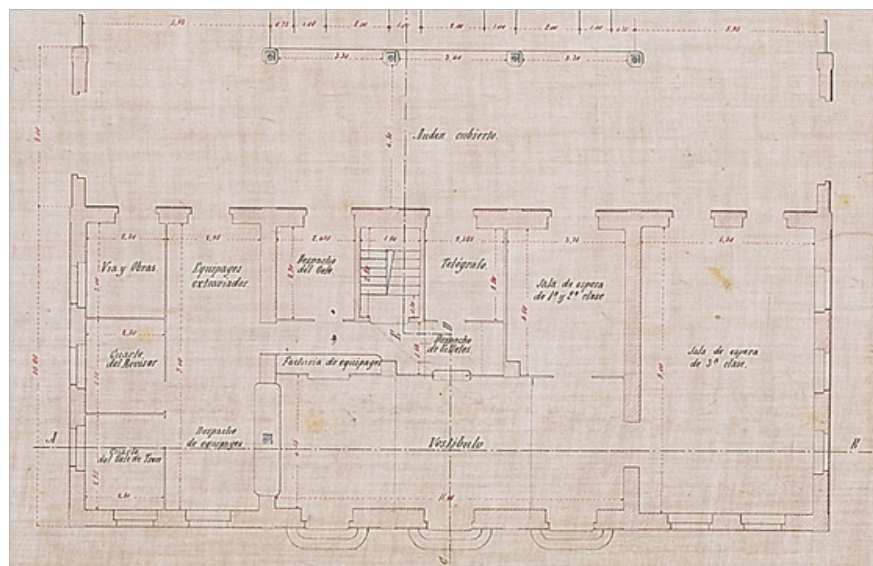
Detalle de planta baja de la estación de Bétera. 1881. Ing: j. Verdú. Fuente: Archivo de Ferrocarril de la Generalitat Valenciana.
